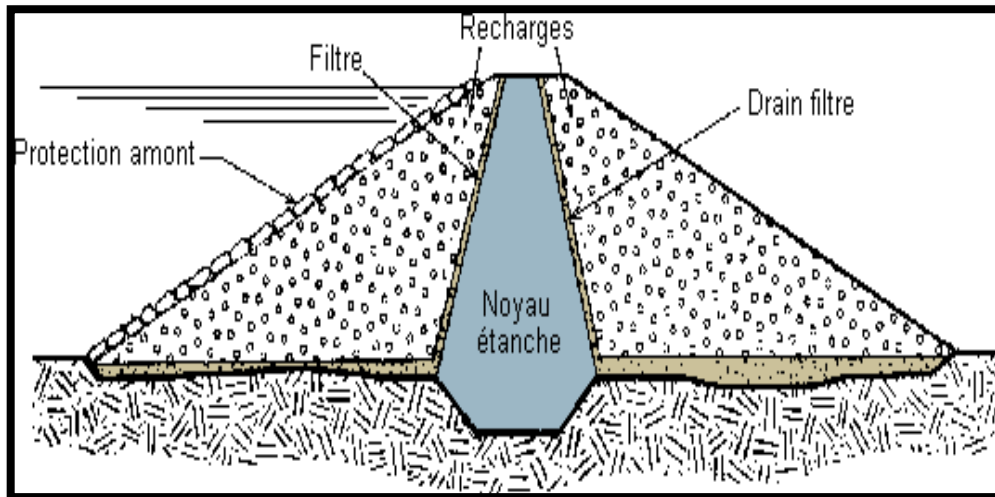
Schéma d'un barrage en terre a noyau étanche
